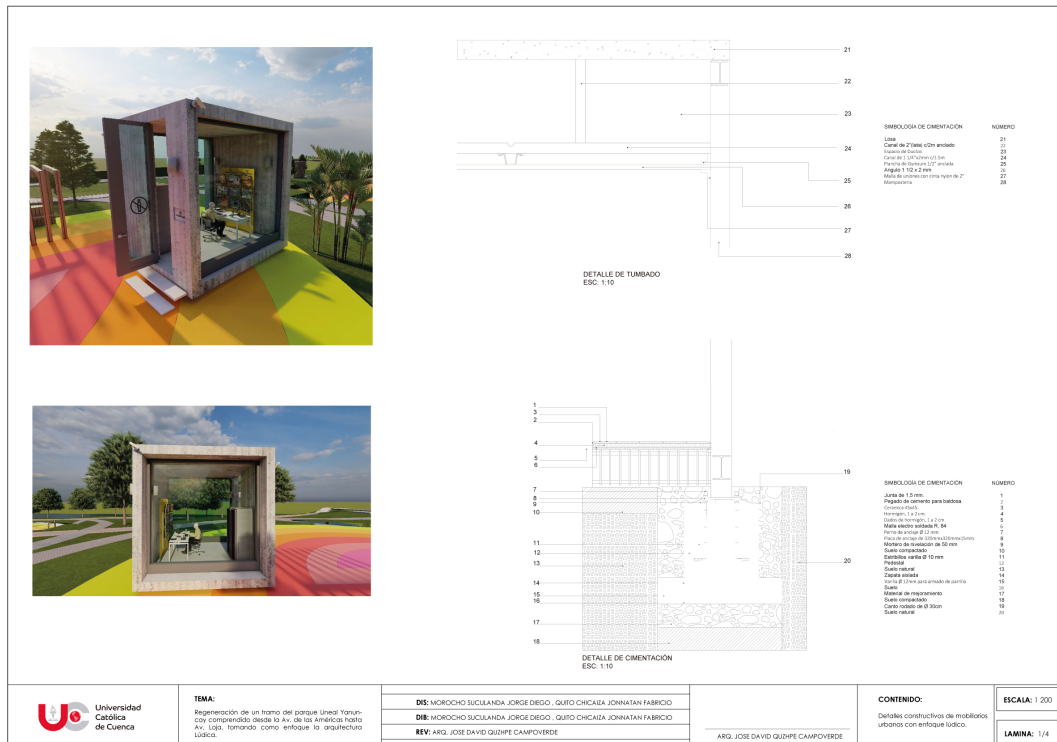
Detalles Constructivos. Fuente : Propia
